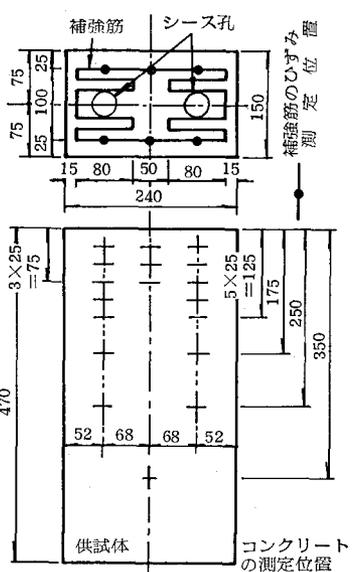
供試体、補強筋およびひびわれ測定位置 単位:mm
